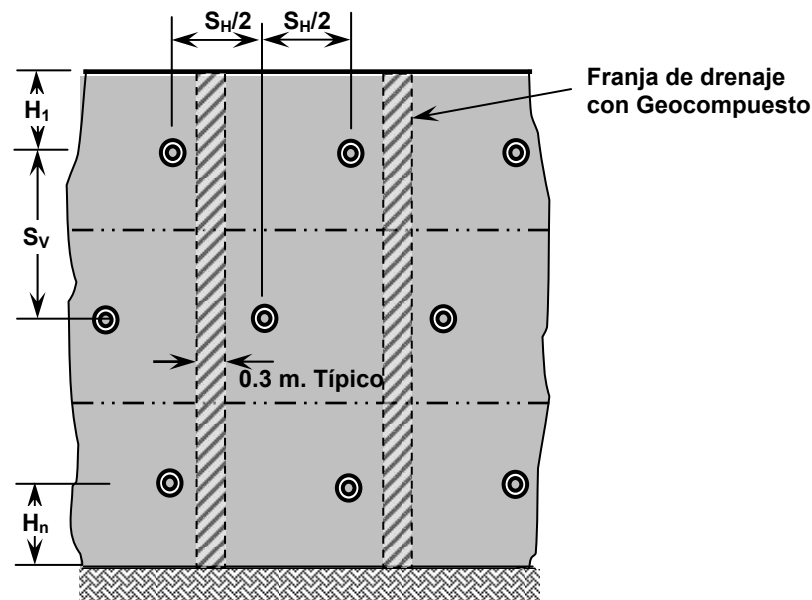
Espaciamiento uniforme de la columna de Nails.
